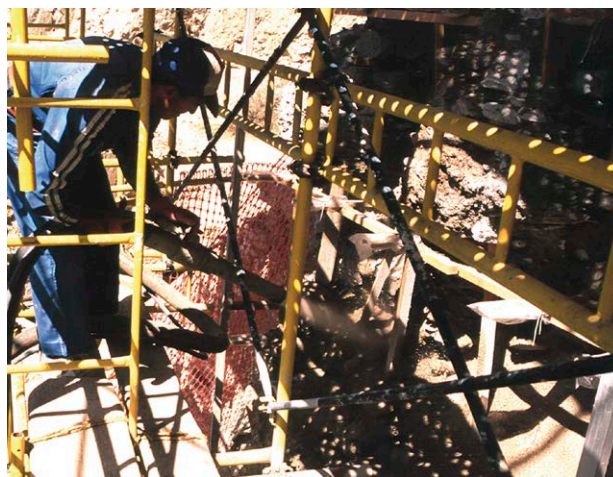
Proyección de hormigón de cal sobre el muro (1995)
